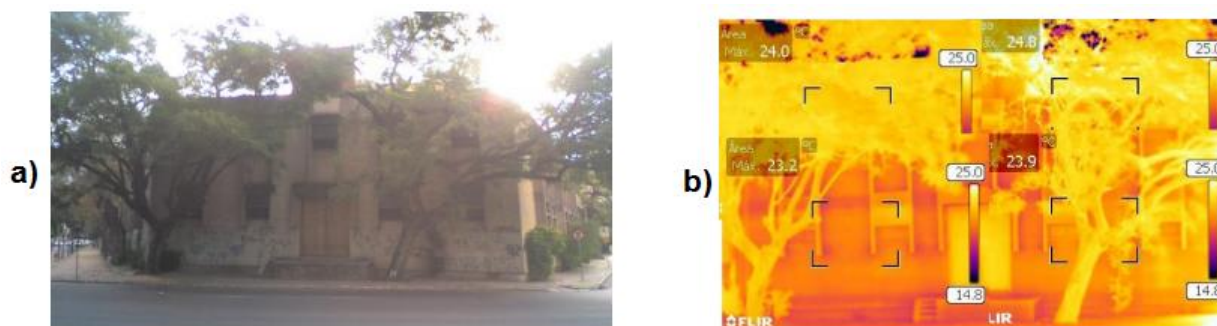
a) Levantamento visual da fachada Sudeste. b) Levantamento termográfico da fachada Sudeste.
